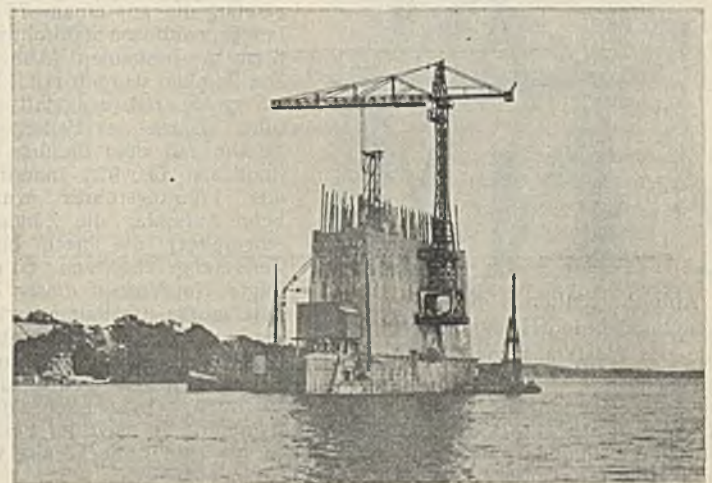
Ansicht eines Kranes mit Laufkatze beim Betonieren eines Pfeilers der Brücke über den Kleinen Belt.
